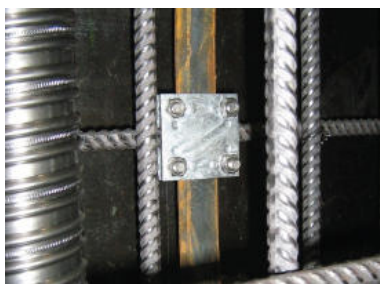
Verbindung Blitzschutzseisen mit Bewehrung
